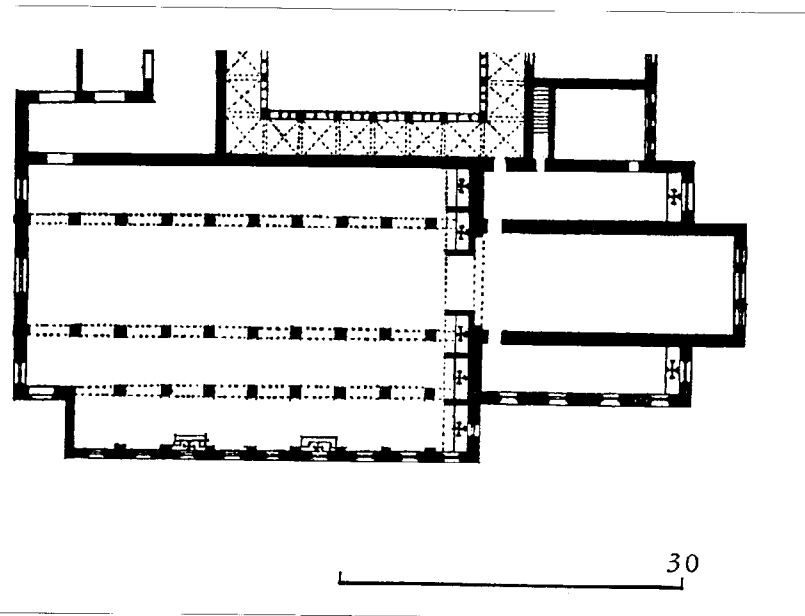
Konstanz, Predigerkirche (um 1270 fertiggestellt ?), Grundriss.
